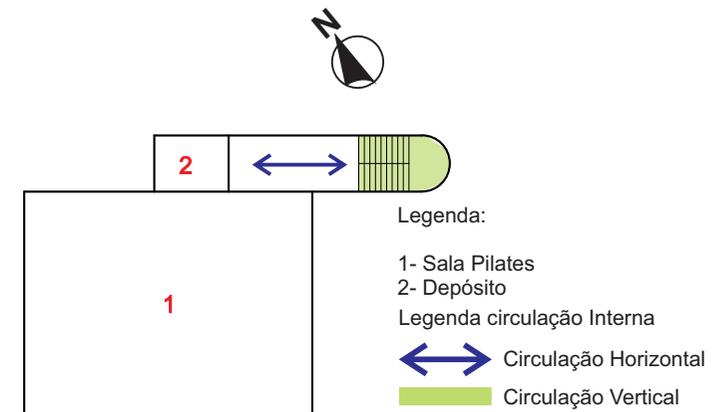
Planta Baixa esquemática terceiro pavimento IAFF.
